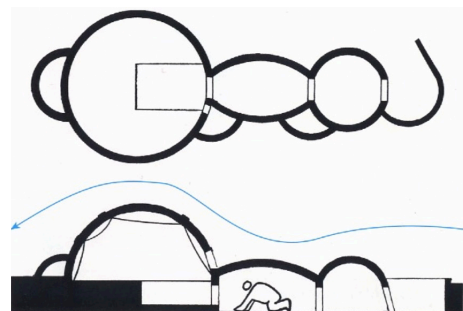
Planta y sección de un iglú. Fuente: (Neila González, 2004)
